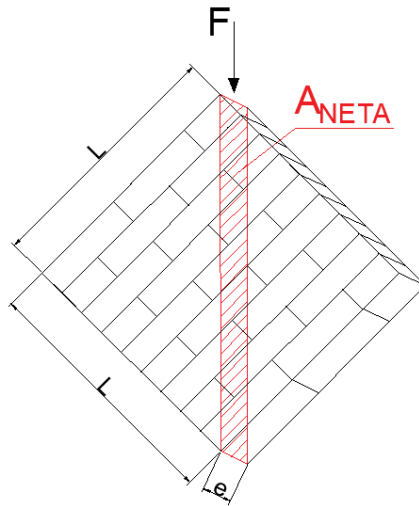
Esquema parámetros y geometría en ensayo de murete a compresión diagonal.
